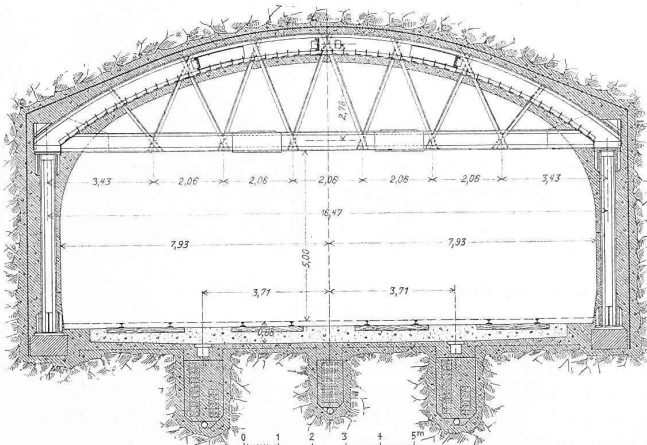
Profil der viergeleisigen Strecke des Tunnels unter dem North River. — Masstab 1 : 200.
